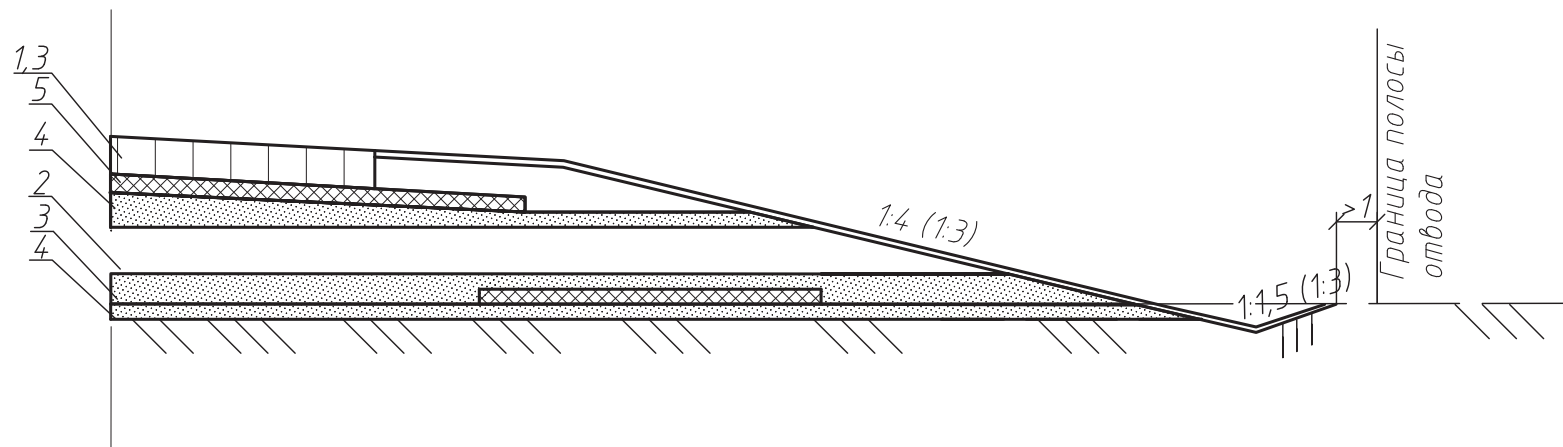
Тип 2. Насыпь высотой до 3(2)м с боковыми резервами и кюветами
